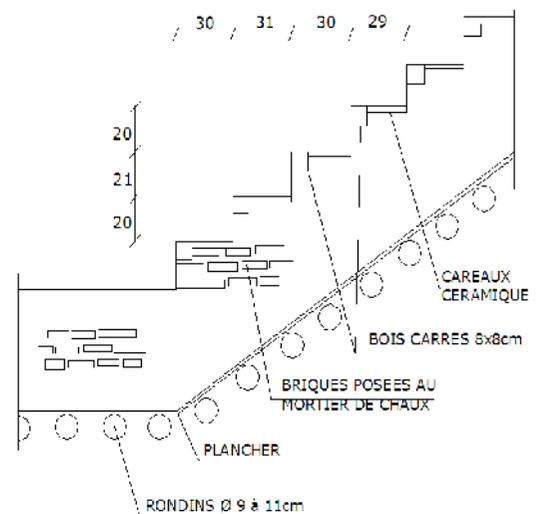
escalier conçu Parallèlement et au mur de façade à Dellys
